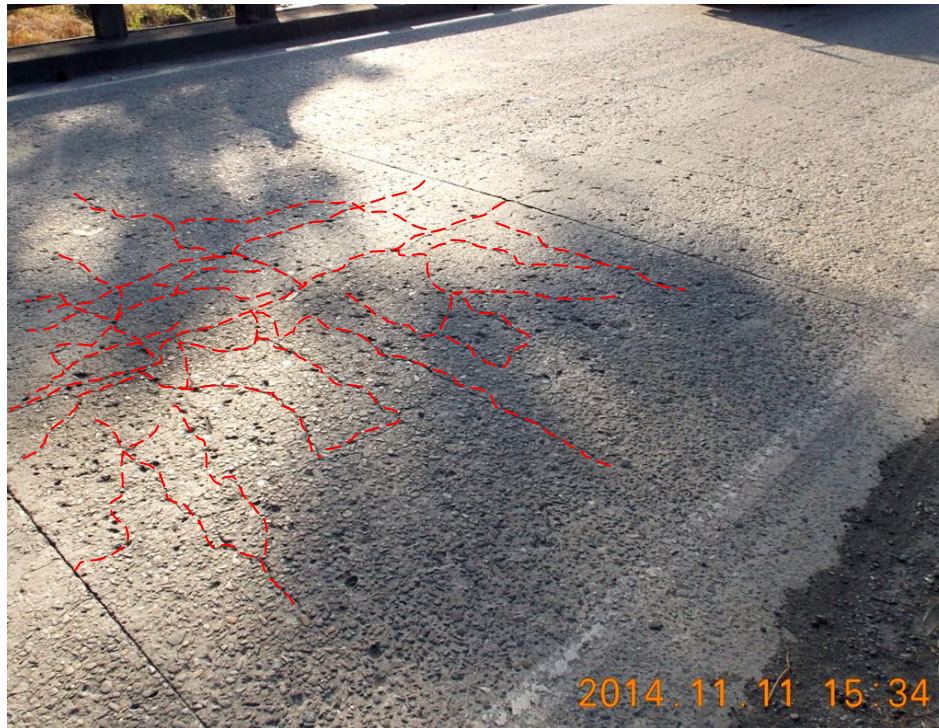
Agrietamiento en dos direcciones de la cara superior de la losa de concreto.
